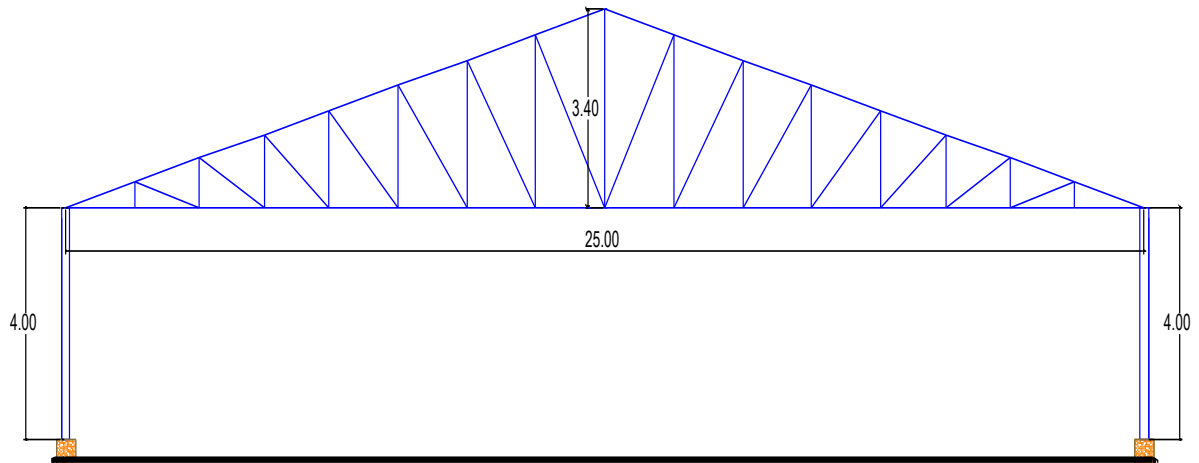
Vista frontal del modelo de armadura tipo HOWE: Fuente propia
